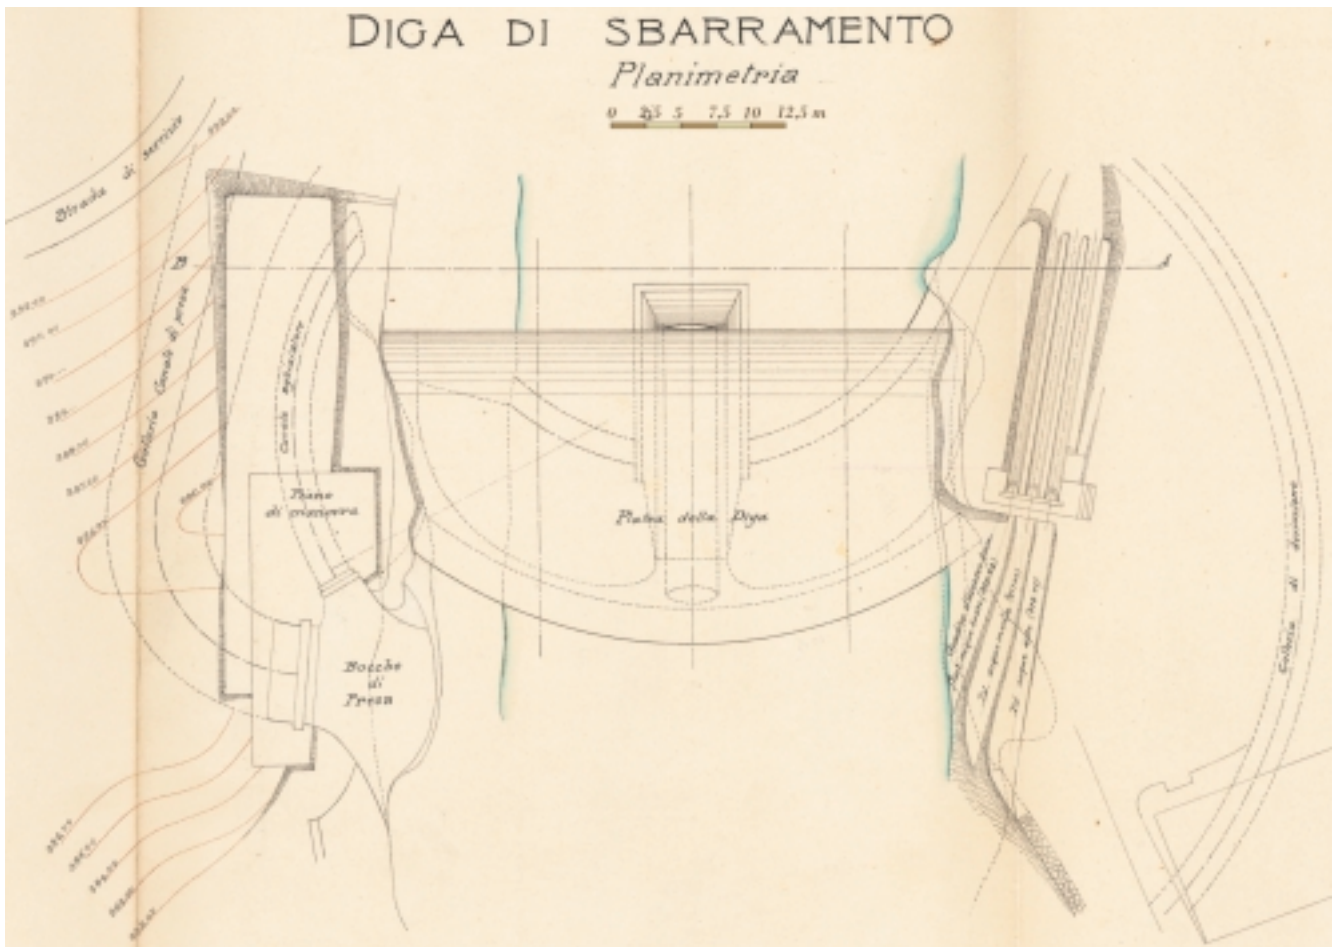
Diga di Ponte della Serra: planimetria generale.
